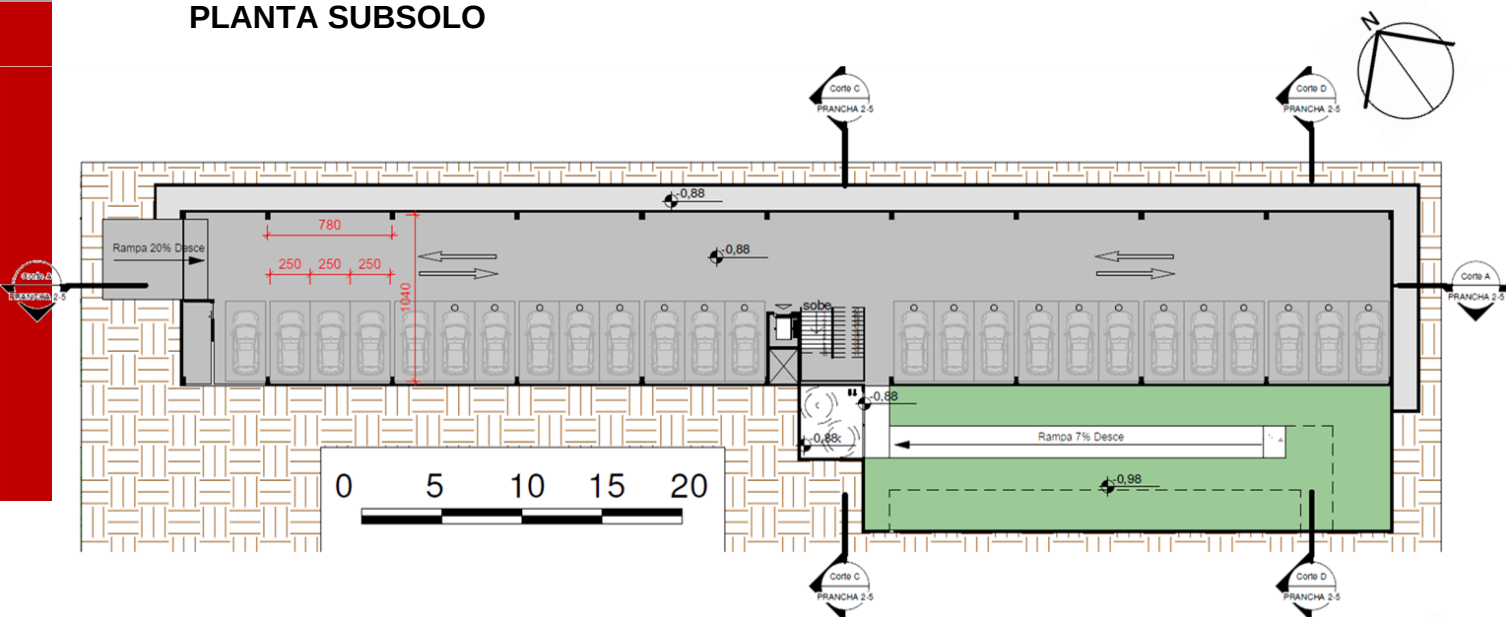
Planta Baixa do Subsolo. Feito no Revit.
